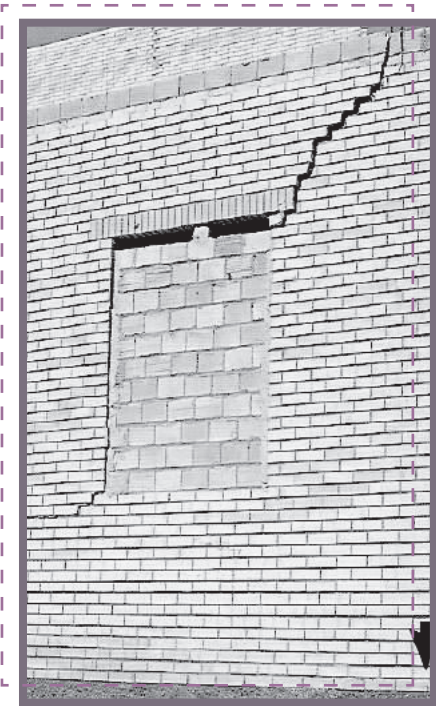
Imagen de las fisuras por asiento de una cimentación corrida de hormigón armado.
